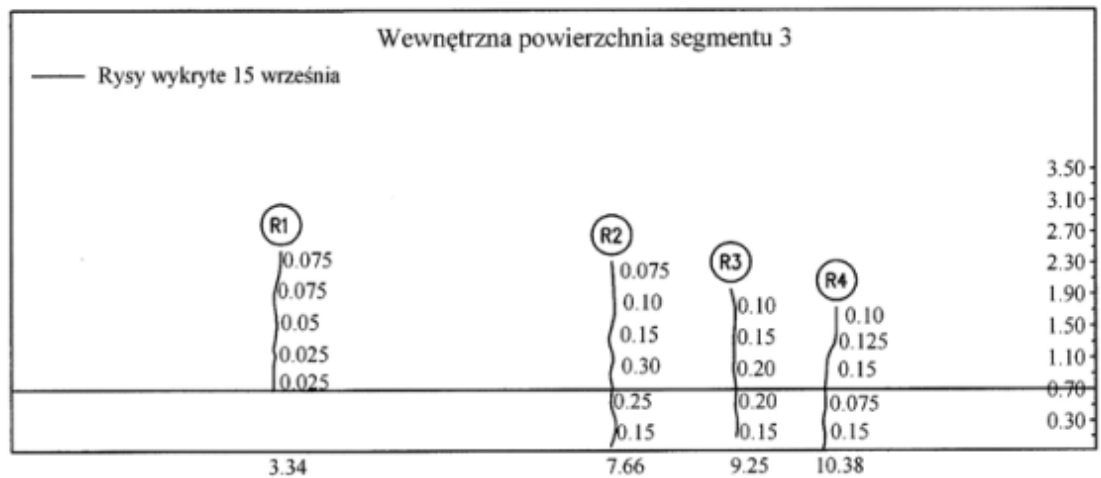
Seinän 2 halkeamien sijainnit ja mitatut halkeamaleveydet. [60]
